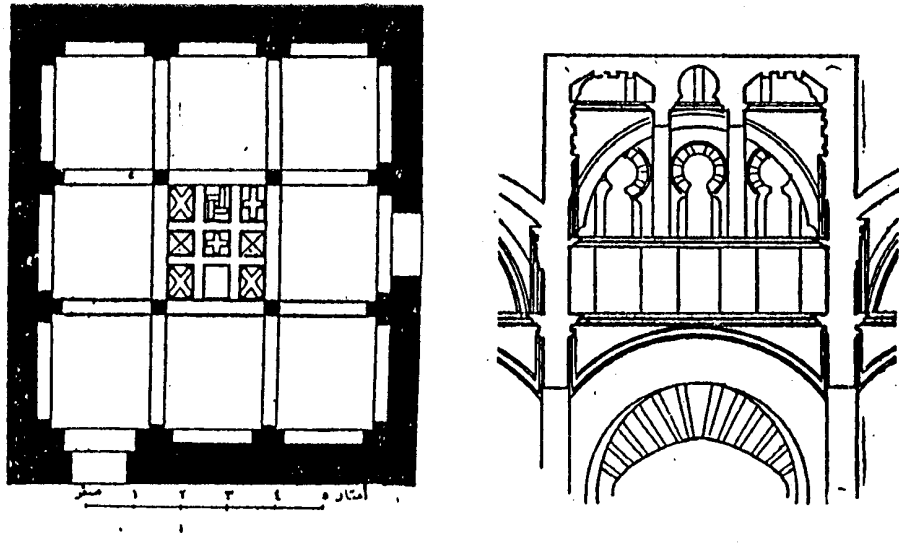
مسقط أفقي لمكتبة راغب باشا في استانبول
